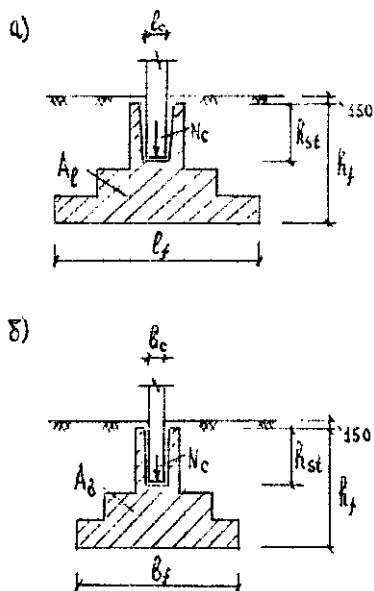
Площади вертикальных сечений фундамента A_l (а) и A_b (б) при его расчёте на раскалывание
